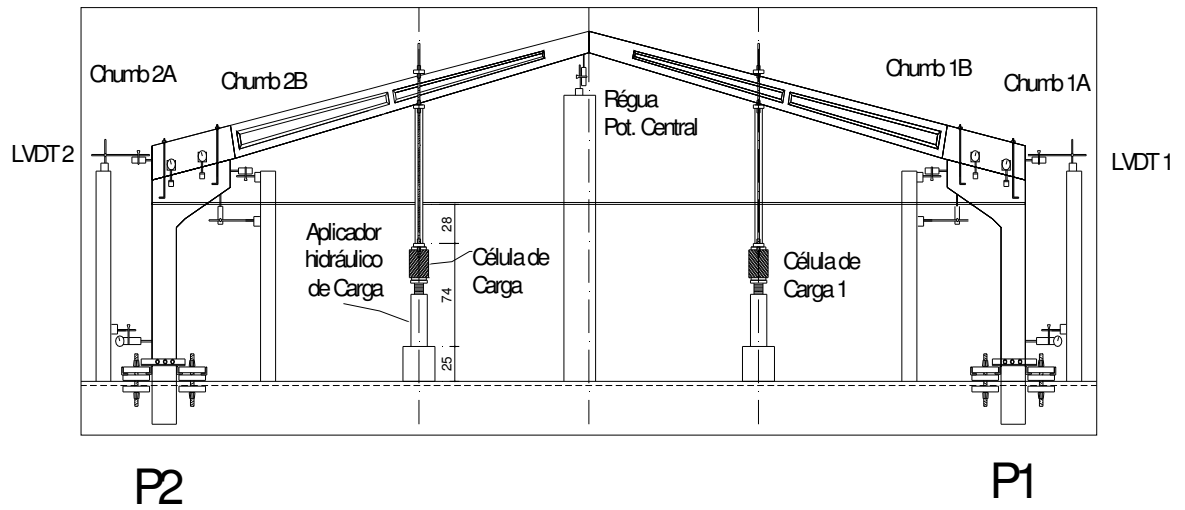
Croqui do pórtico instrumentado a ser ensaiado e sistema aplicador de carga
